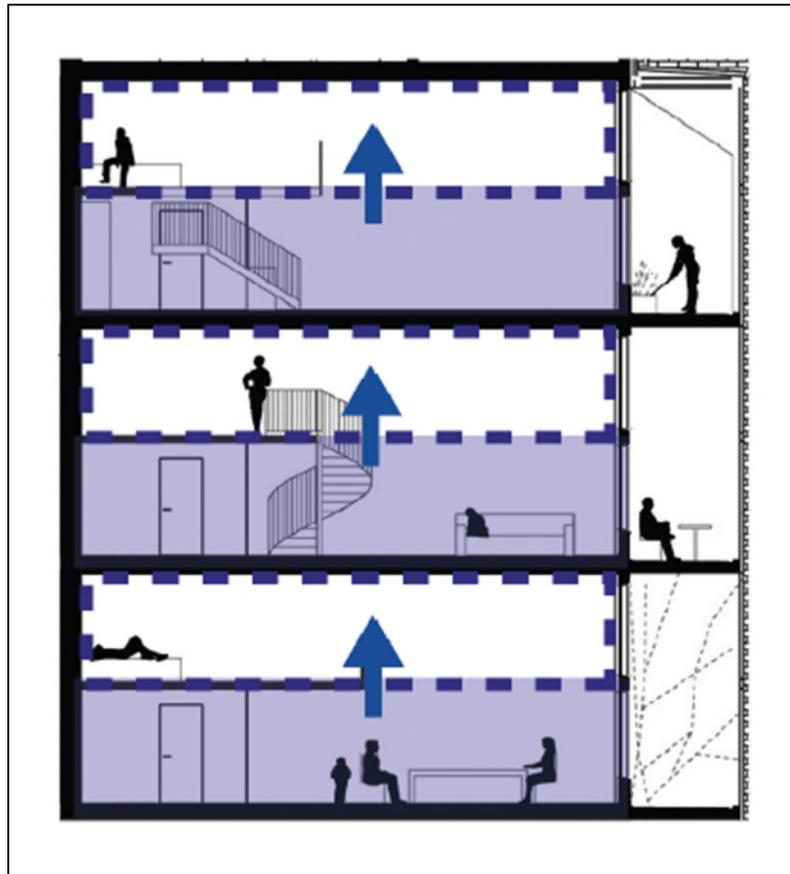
Coupe montrant la hauteur considérable permettant d'augmenter l'espace de vie, source : FLEURI Maya, *Espaces-temps : entre hier et aujourd'hui, l'habitat évolutif pour demain*, ENSA de Nantes, 2021
